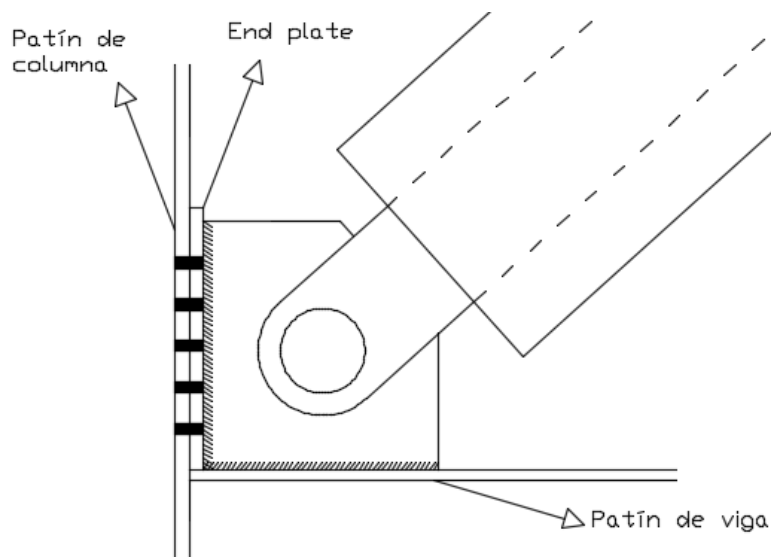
Configuración propuesta para conexión de gusset plate.
